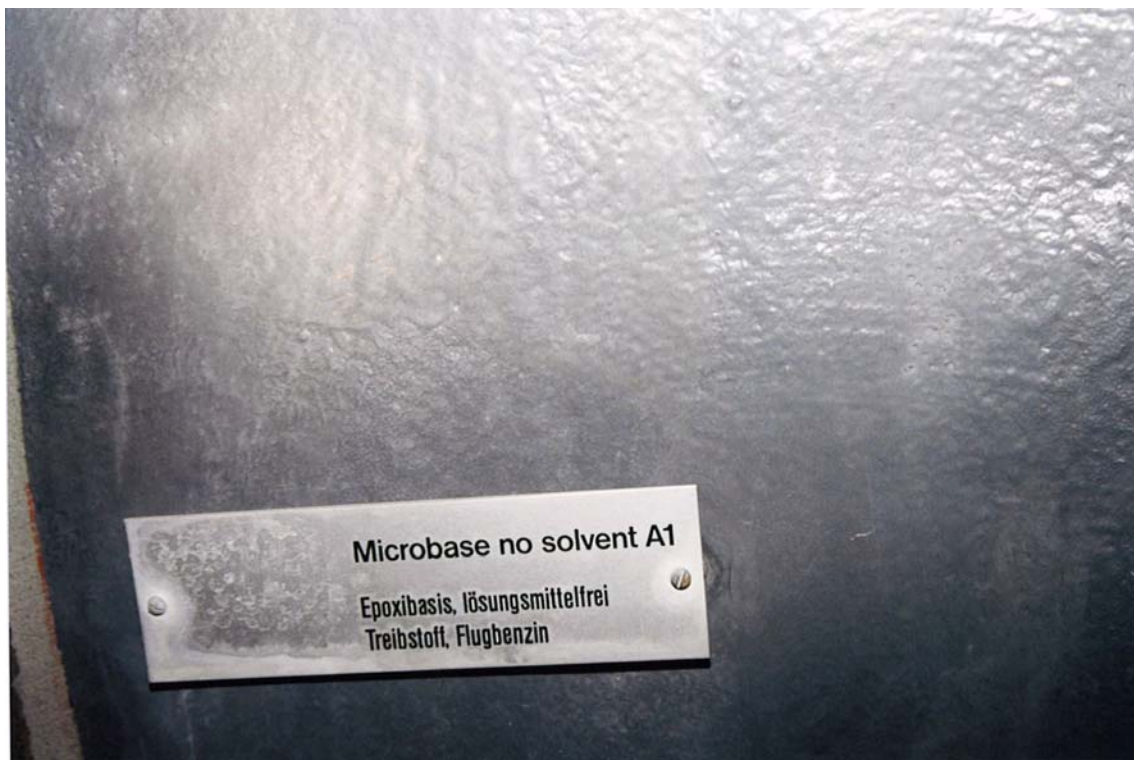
/17: Abdichtung, kohlenwasserstoffbeständig
